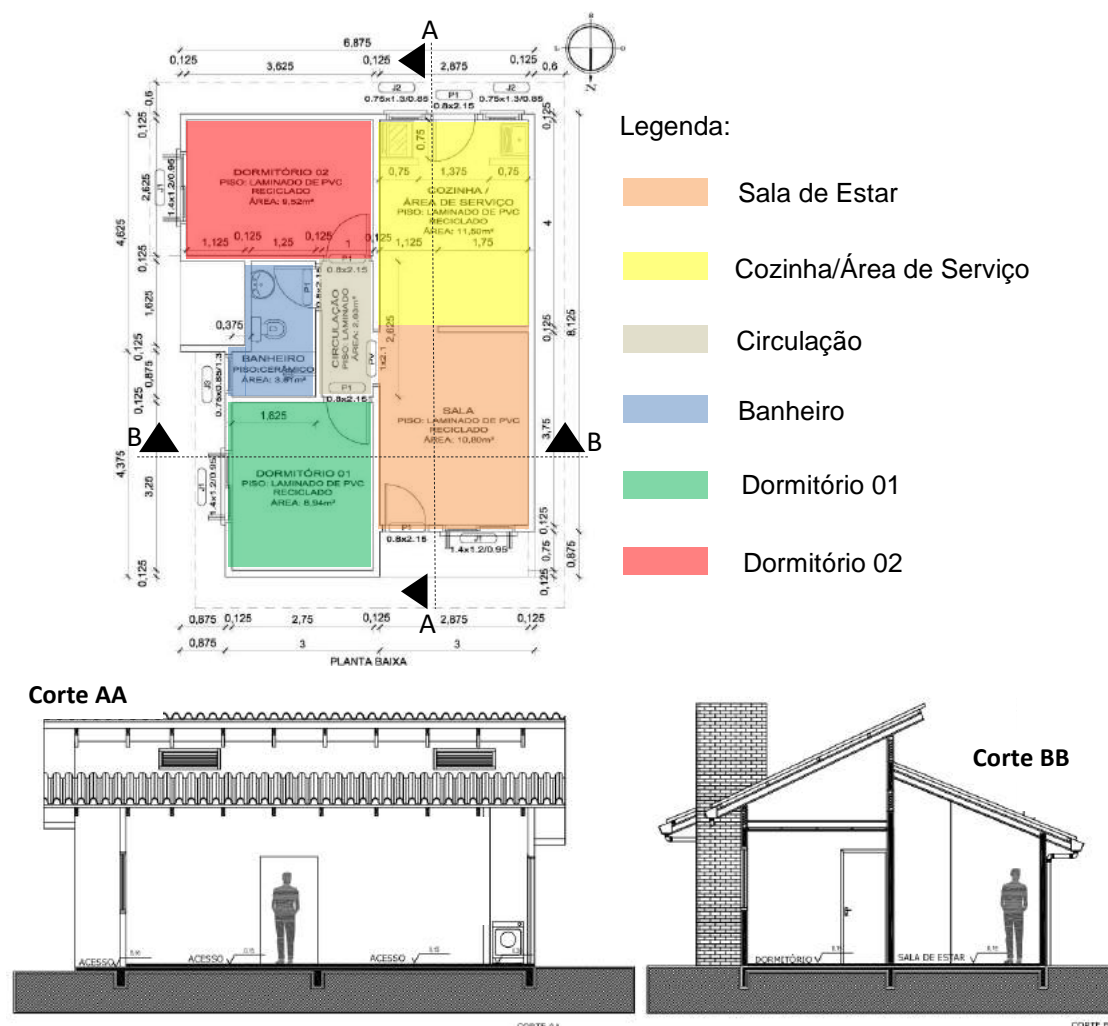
Planta Baixa do protótipo, Corte AA e Corte BB. Fonte: adaptado de GEPETECS, 2014
